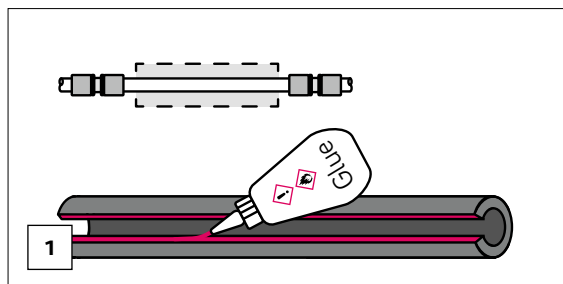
Preparare l'isolamento separatamente dal tubo. Applicare l'adesivo adatto al giunto di testa.
